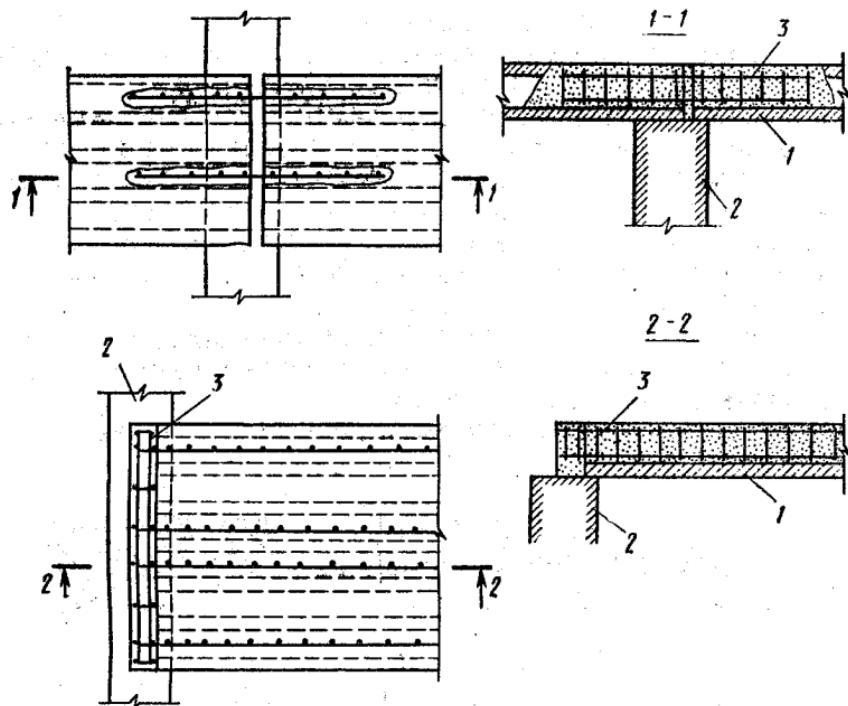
Усиление опорных частей многопустотных плит:
